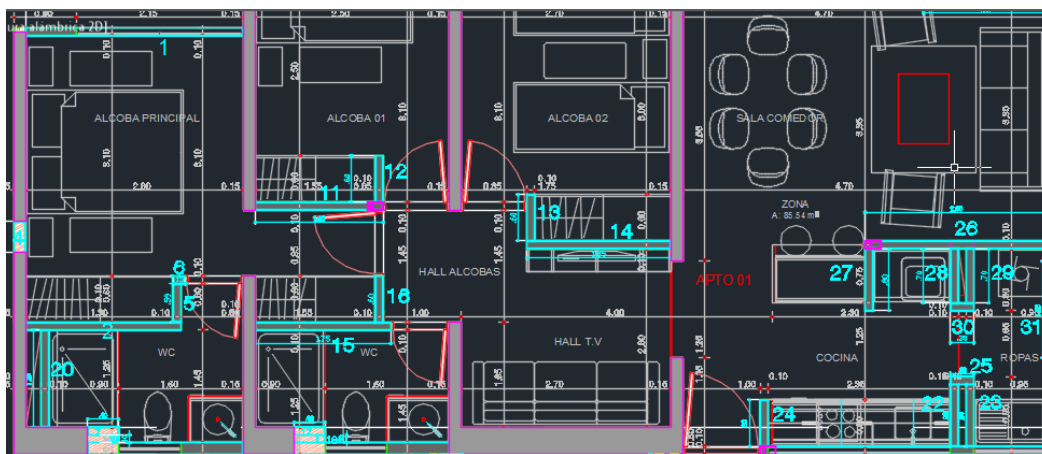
Memoria de mampostería y friso interior de apartamento tipo
